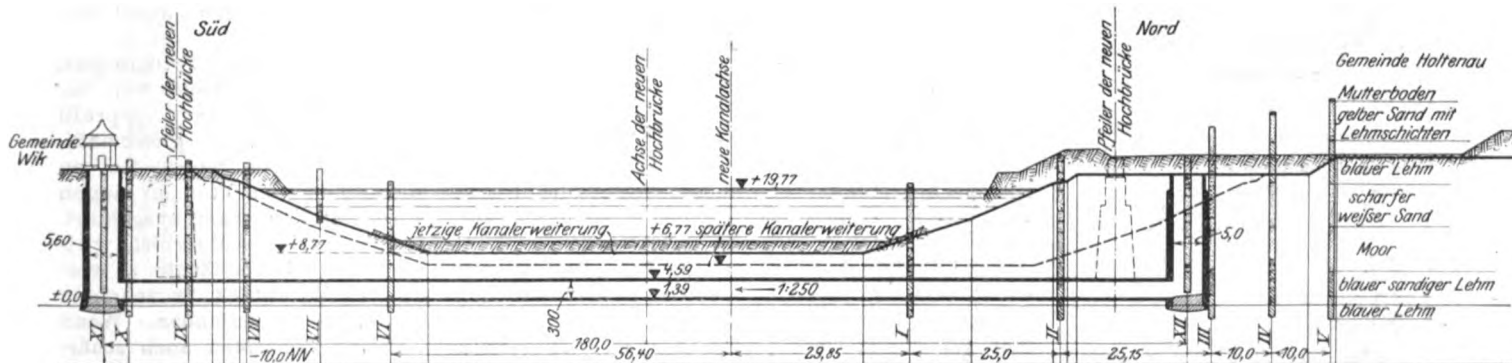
Längsschnitt der Tunnelbaustelle. Maßstab 1:1250.
